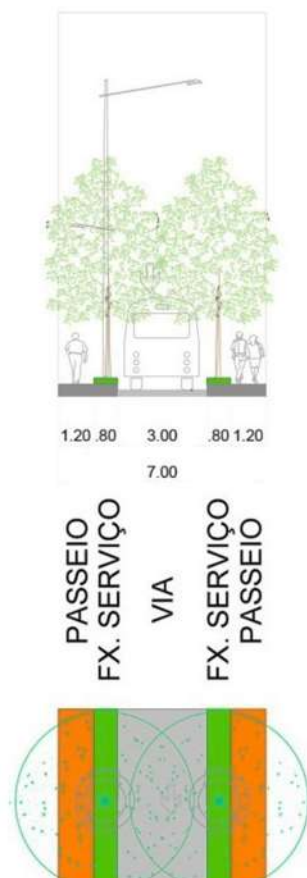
Seção B, R. Idelfonso Cavalcante – Seção Proposta. Elaboração Idom.
